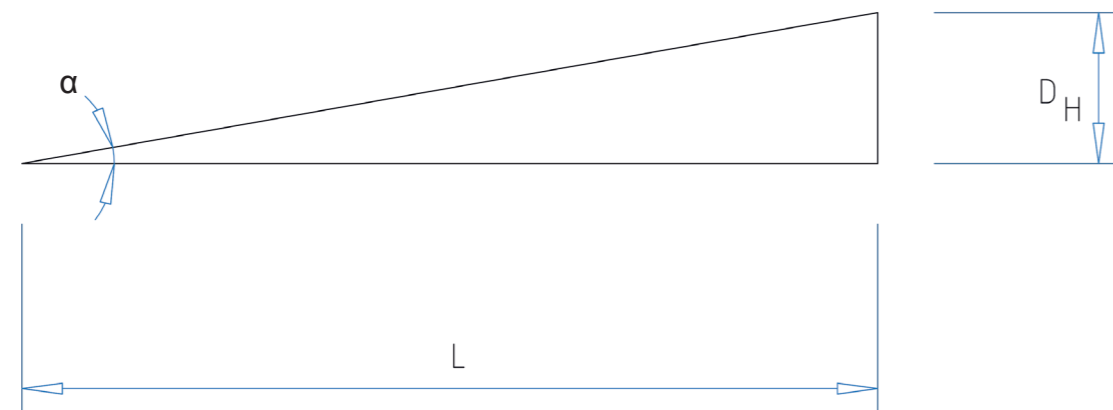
Geometrie der Toranlage mit Gefälleanpassung
